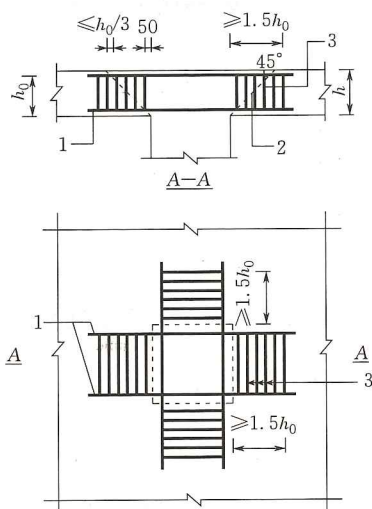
用箍筋作抗冲切钢筋布置图(单位:mm)
